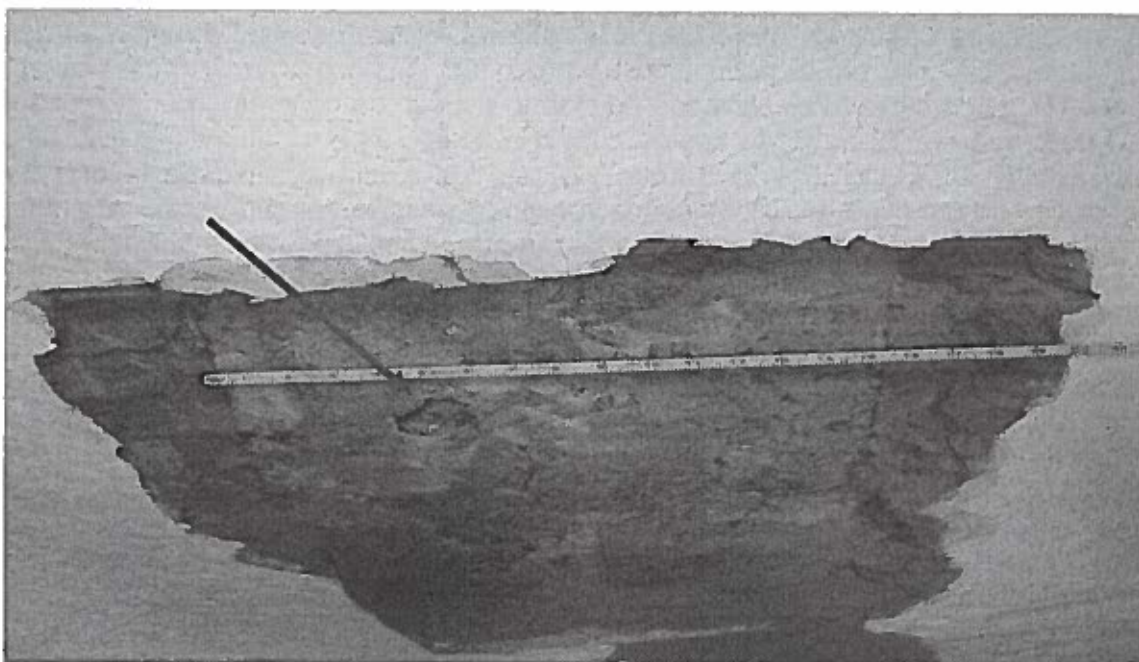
Pilar 27 – Não pôde ser ensaiado – Índice < 20
